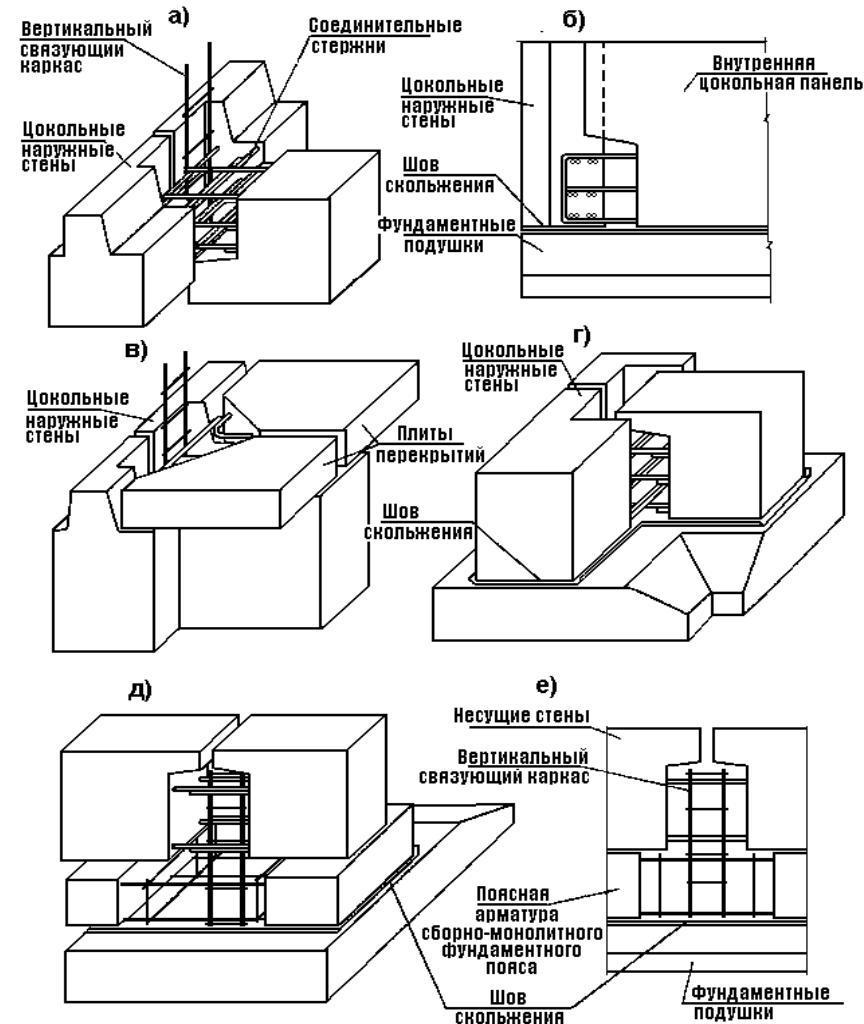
Узлы фундаментов при панельном решении цоколя фундаментов на подрабатываемых территориях.
